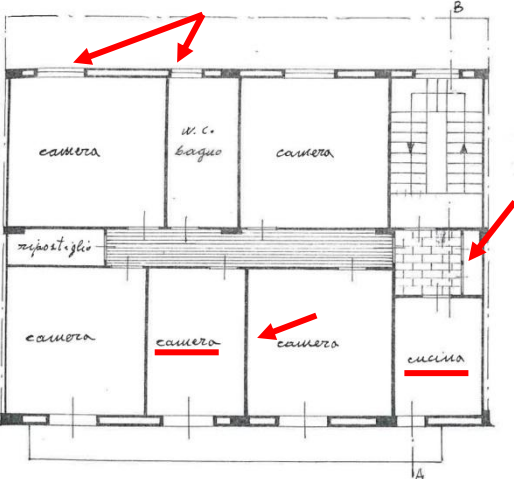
pianta piano tipo all.ta al N.O. del 01.06.1967
